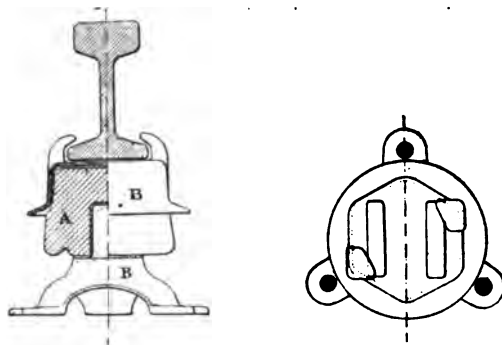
Isolateur pour 3° rail de la ligne de Milan à Varèse (plan, élévation et coupe).
